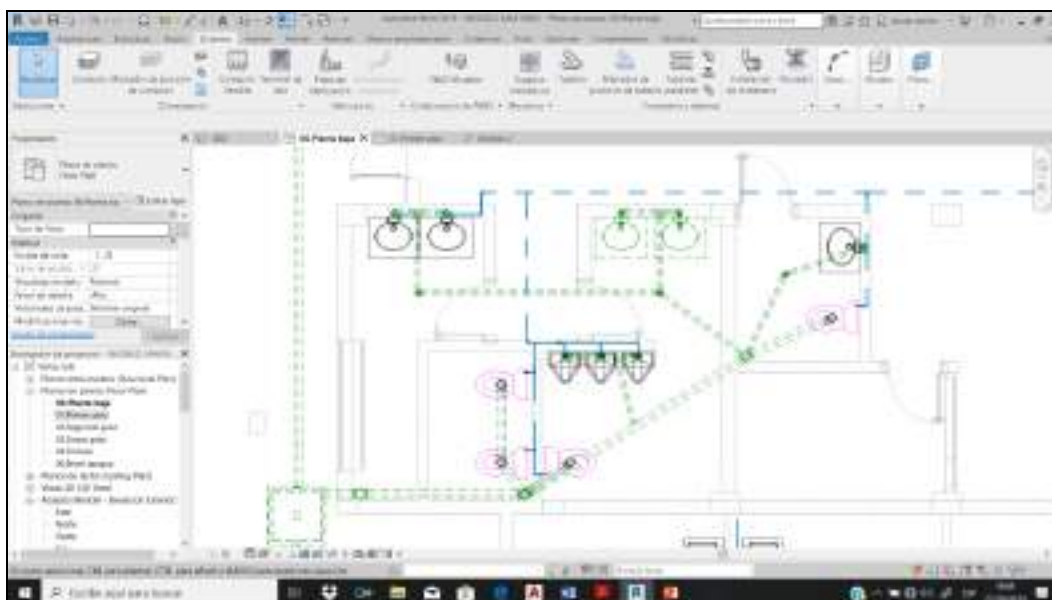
Modelado de tuberías de instalación de agua potable (Vista en planta)
